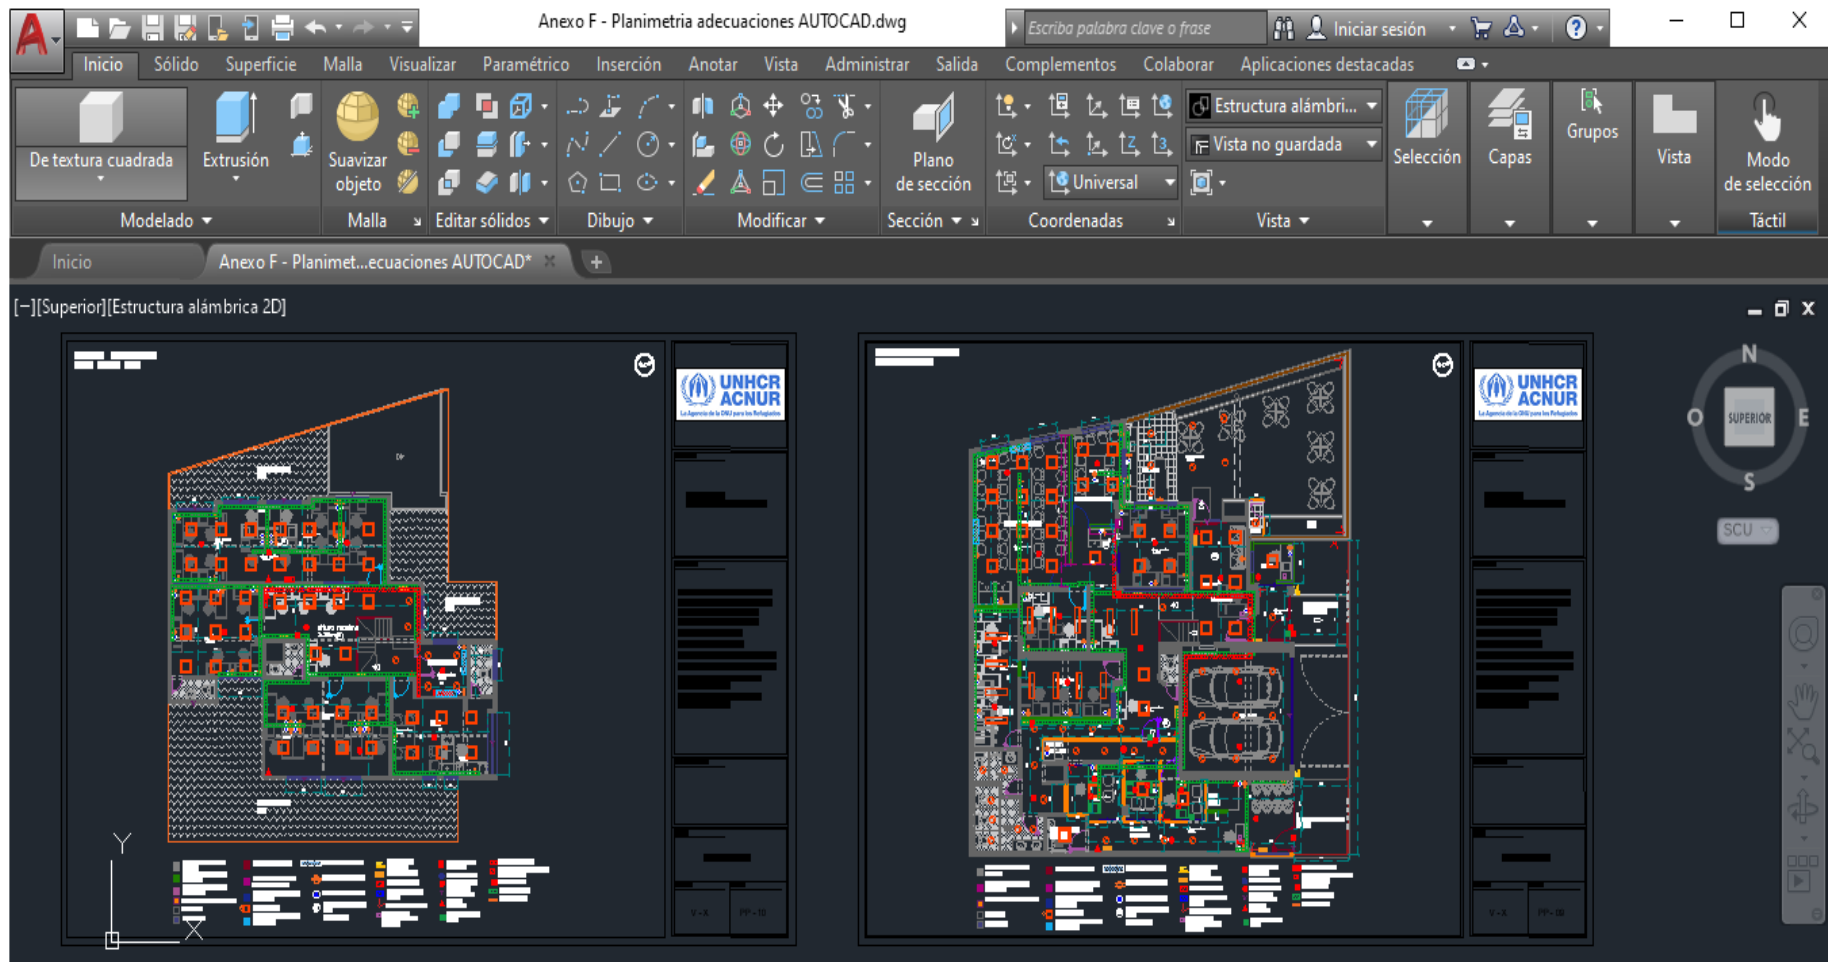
Propuesta Arquitectónica. Fuente ACNUR.
